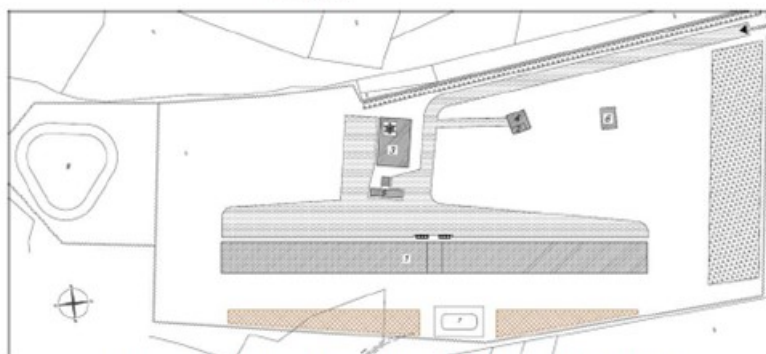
Planimetria allevamento avicolo Chiareto - Bellante (TE)
